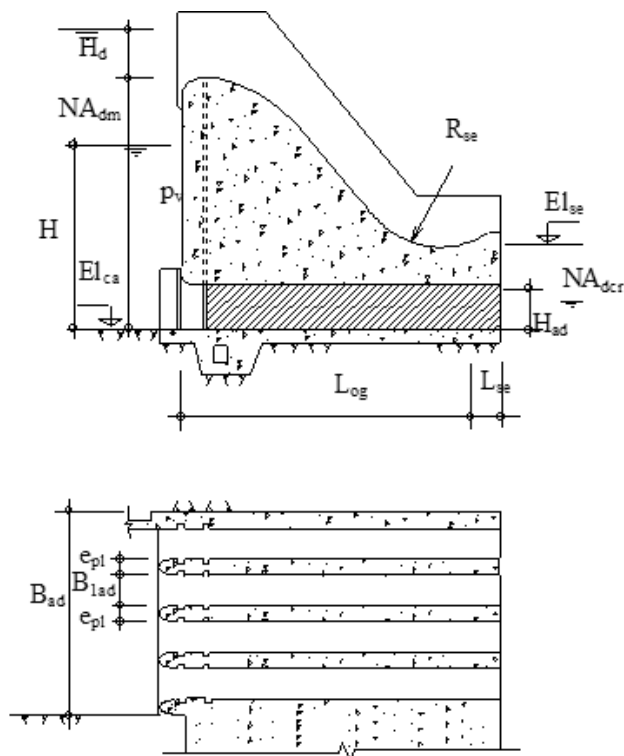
Seção típica e planta de adufas em vertedouro do tipo ogiva alta, com salto de esqui.
